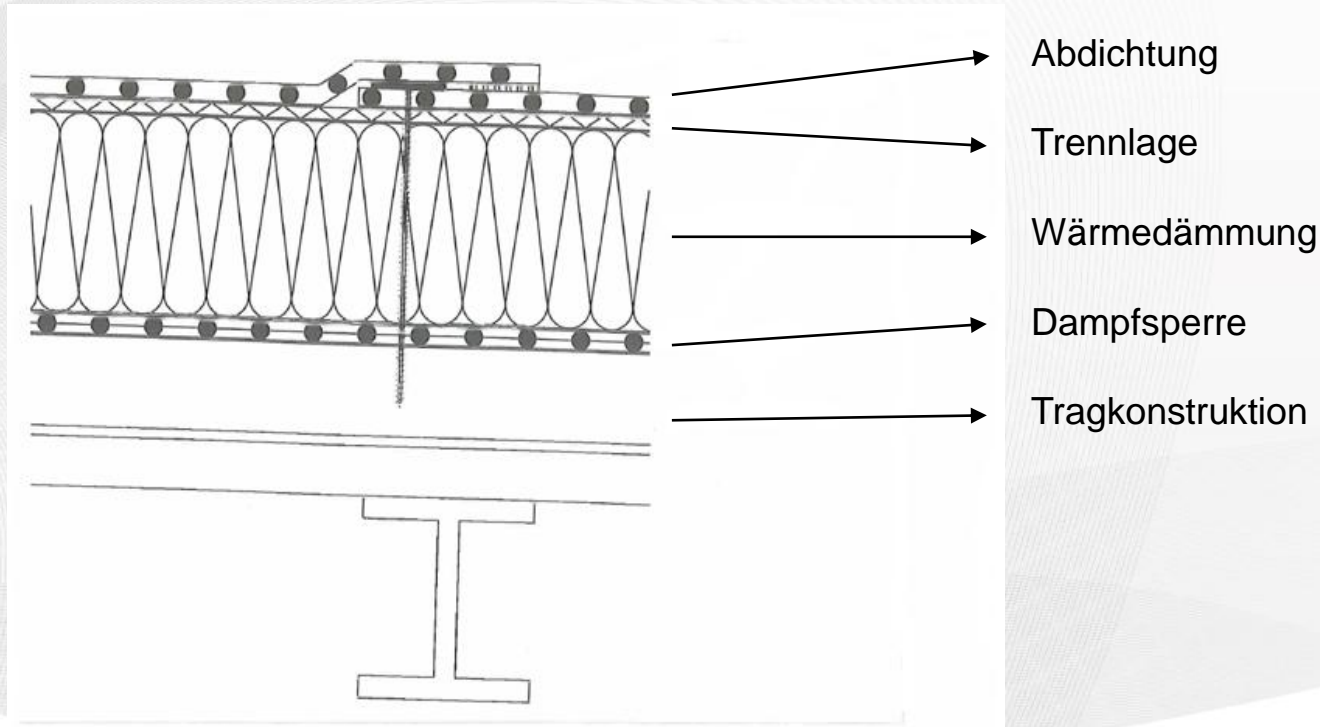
Konstruktionsart: Nicht belüftetes Dach, Abdichtung mit Kunststoff- oder Elastomerbahnen, mechanisch befestigt
